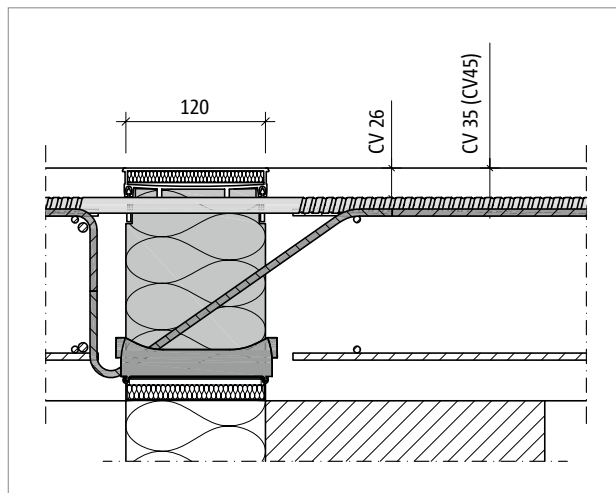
Schöck Isokorb® CXT typ KL: Napojovací stavební výztuž u přímého uložení
